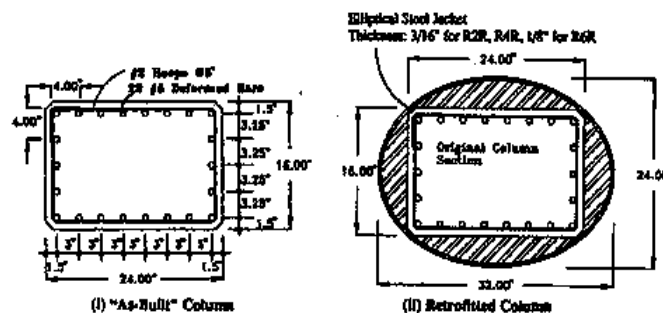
Sección de una columna reforzada con un encamisado metálico, relleno con mortero (Espeche A. 2007).
